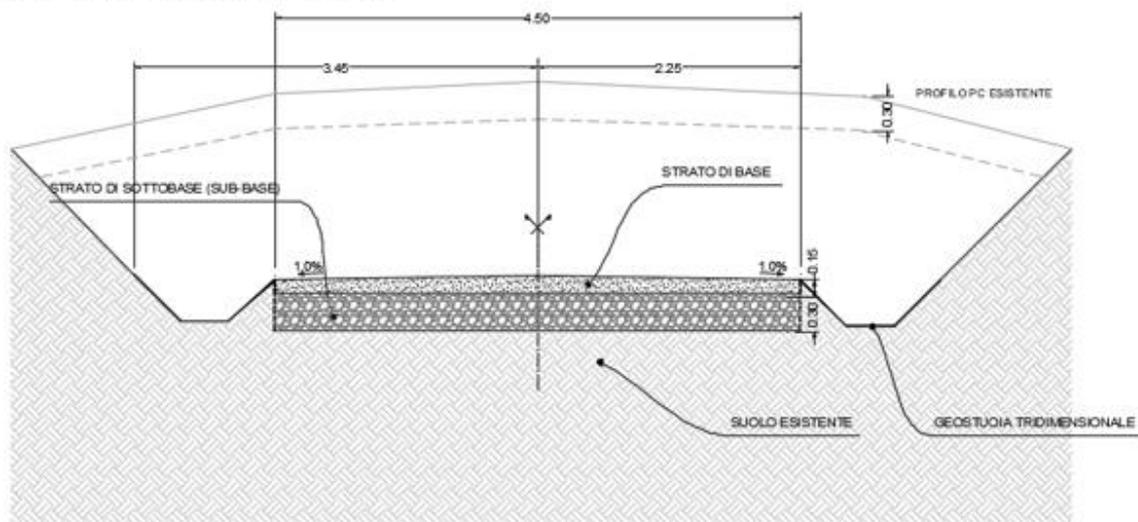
Sezione trasversale viabilità di nuova realizzazione (Fonte: elaborato C23FSTR002WD01600 _Tipico sezione stradale)
